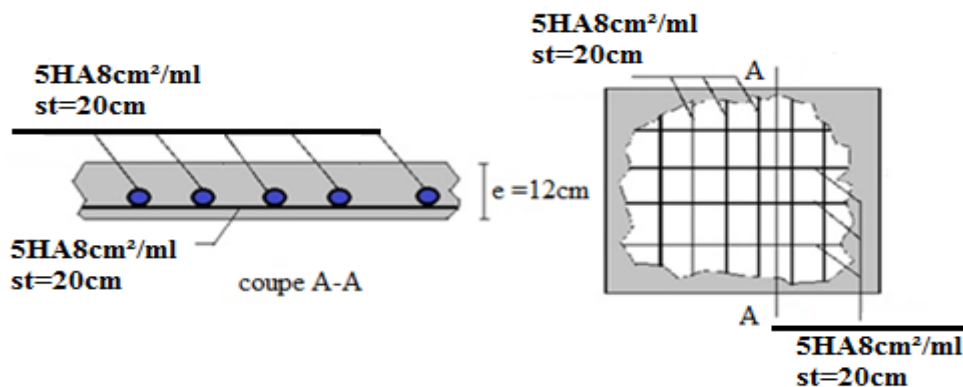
Schéma de ferrailage de panneau de dalle DP1
